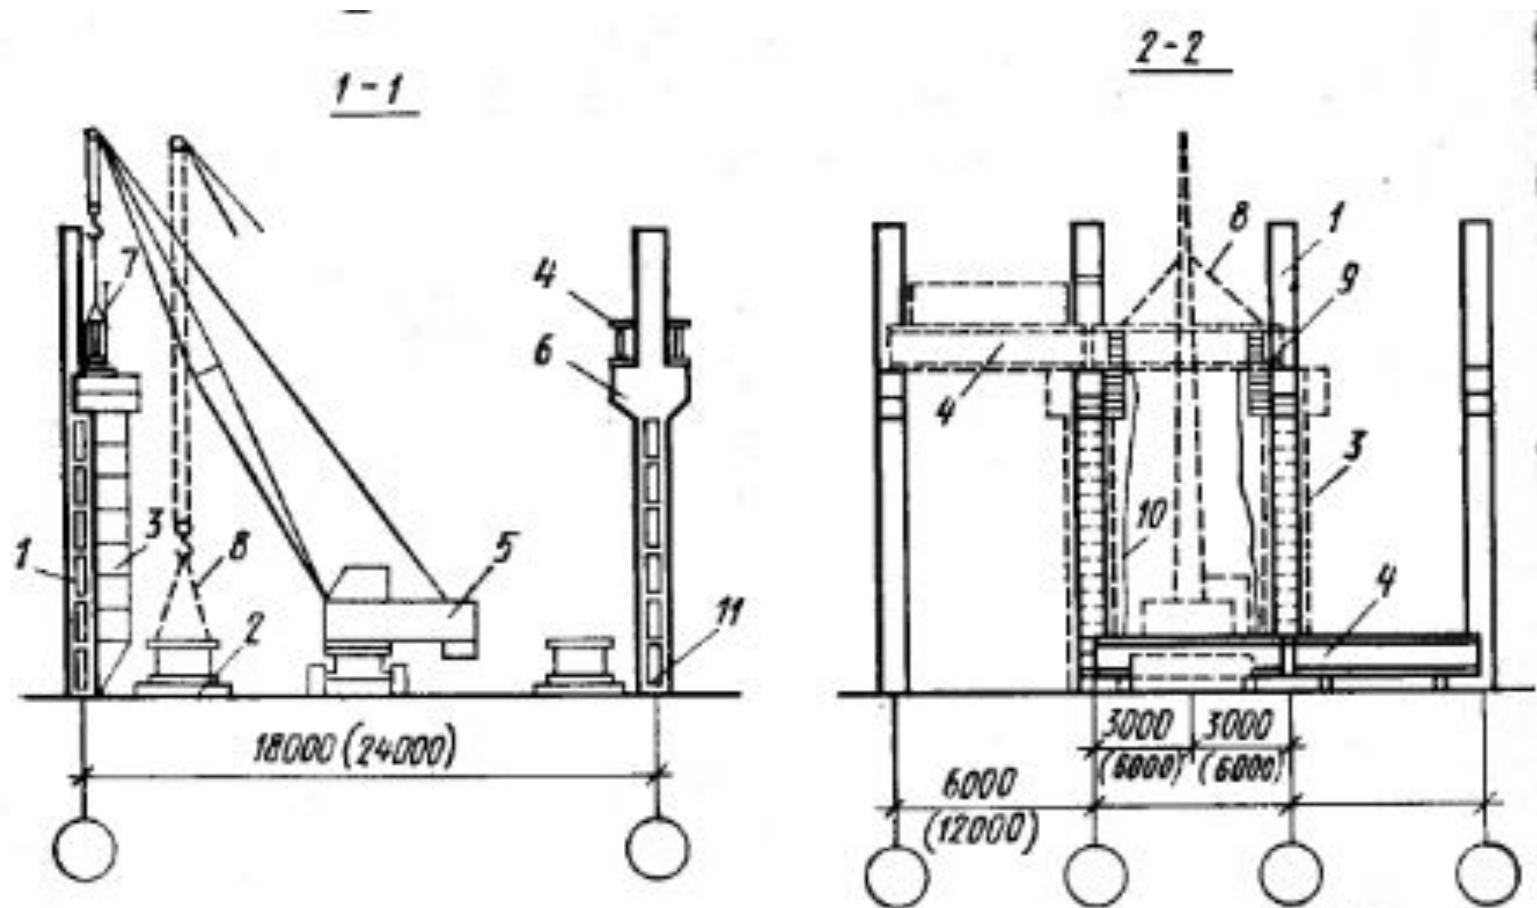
Схема установки подкрановых балок пролетом 6 и 12 м:
